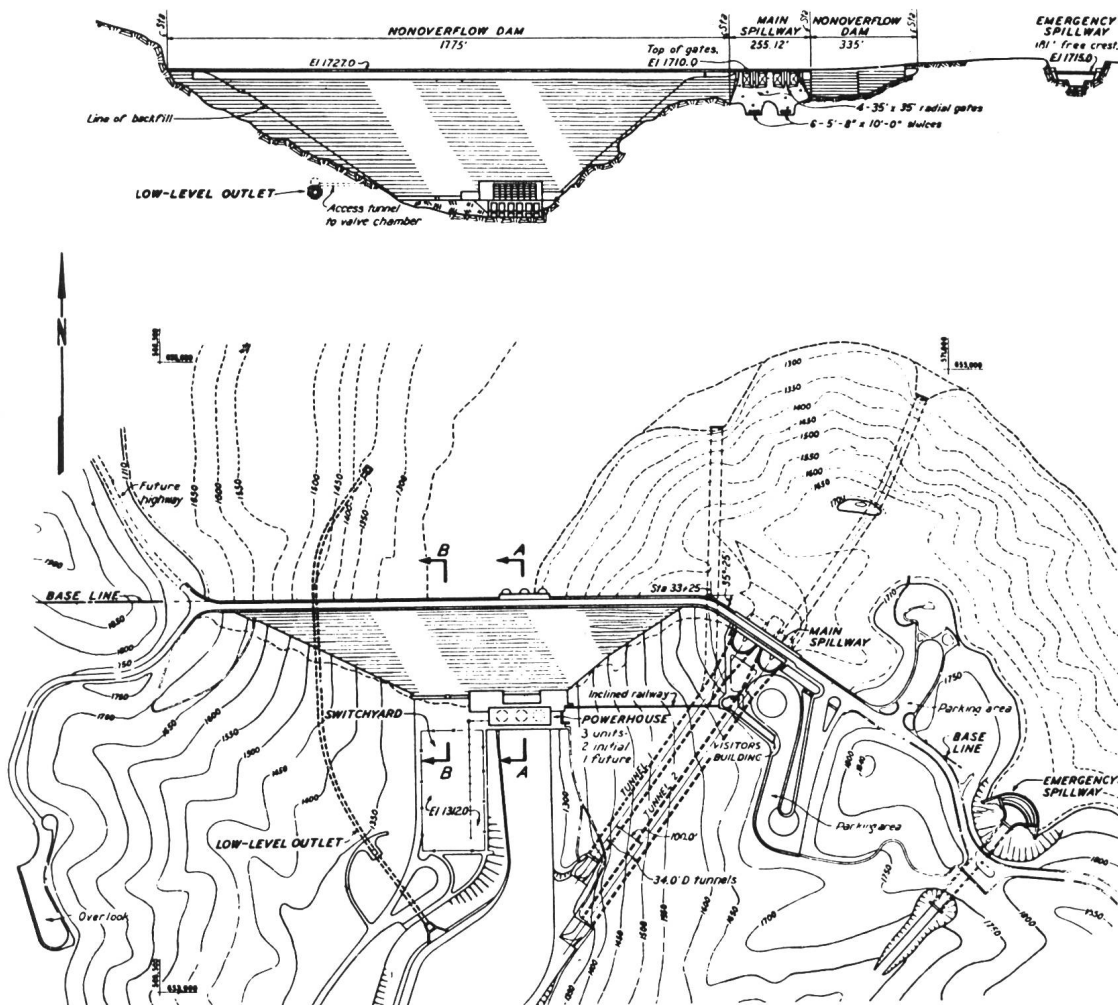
Fontana Dam, Lageplan und schematische Ansicht der gesamten Anlage
